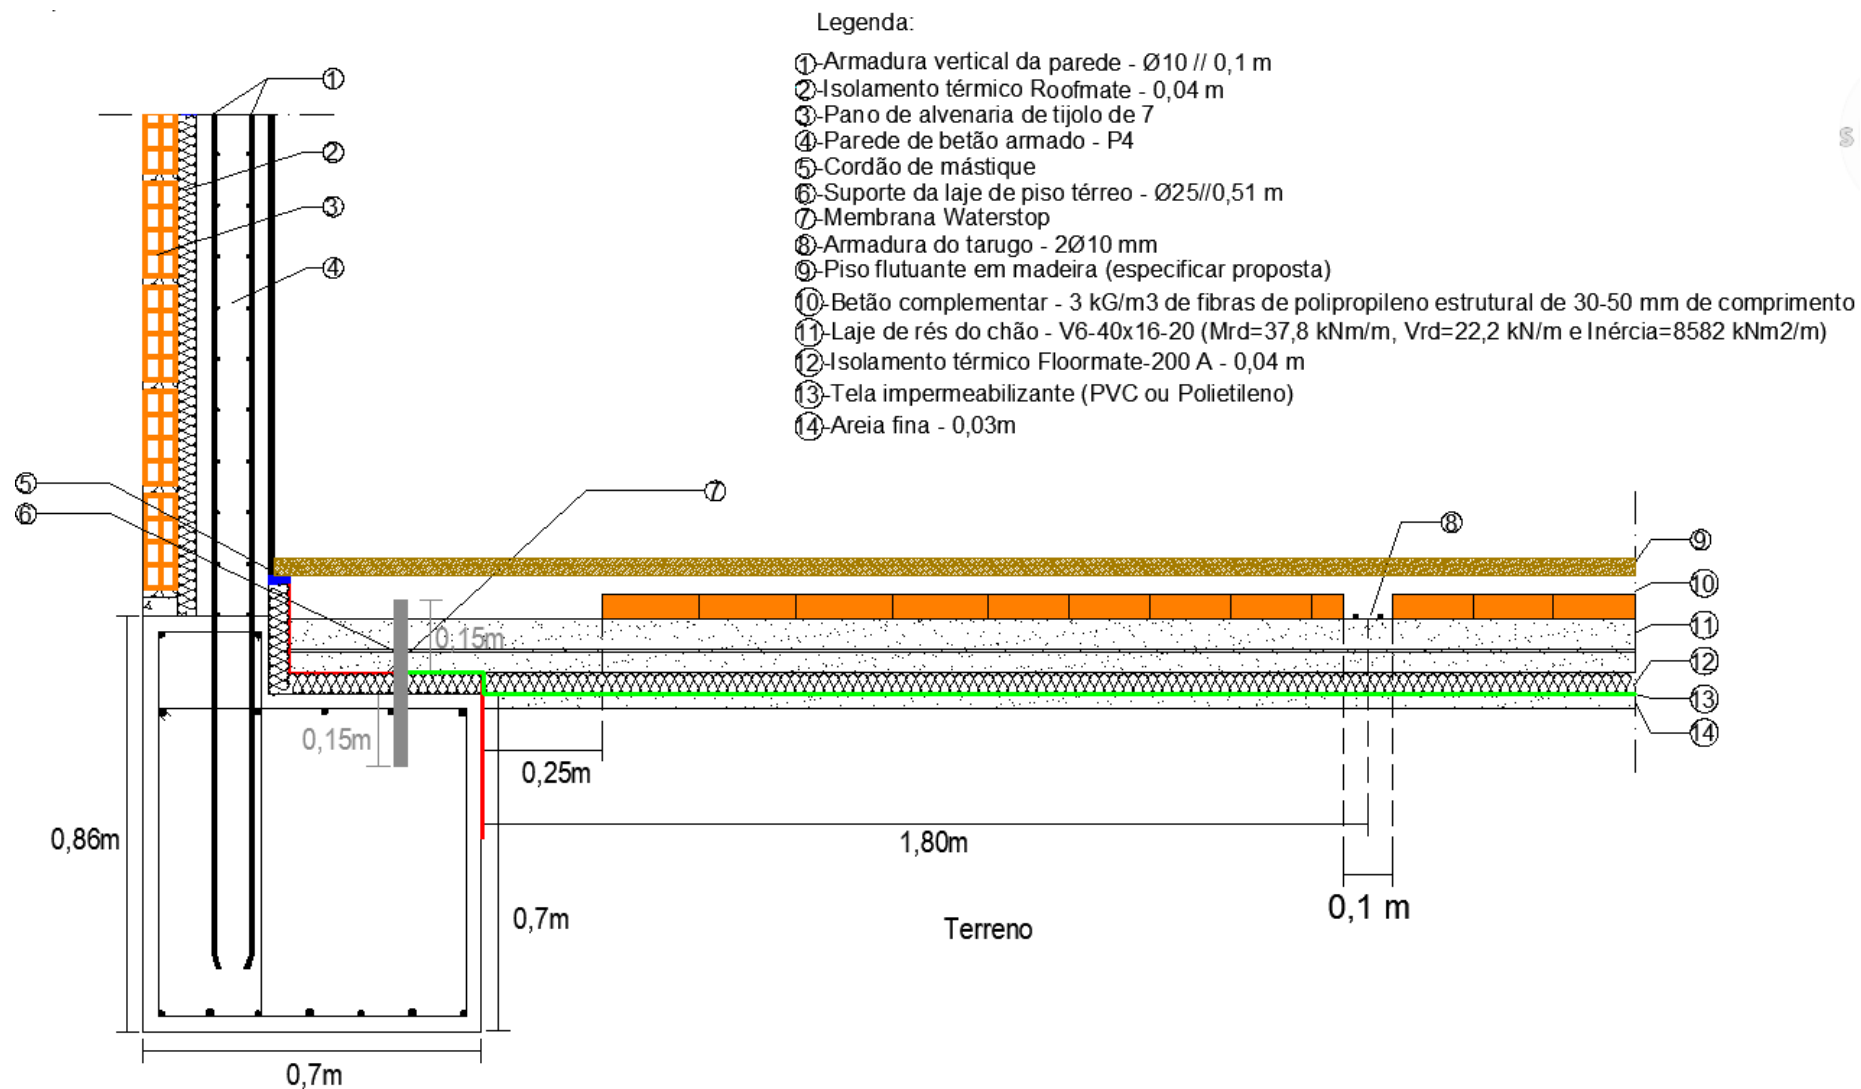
Pormenor da ligação à viga de fundação do pórtico 1-1' – Local da parede
